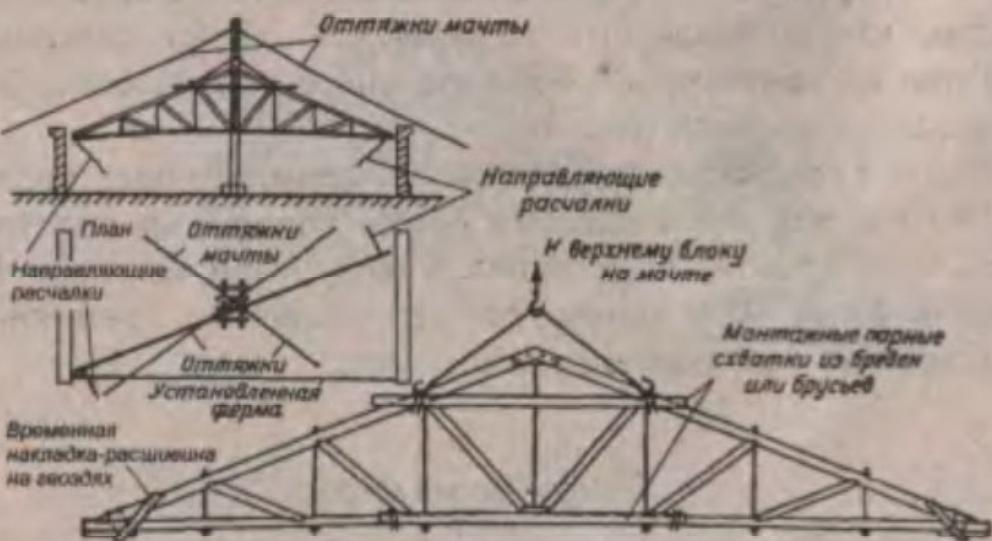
Подъем треугольной фермы на лобовых врубках при помощи мачты на оттяжках
